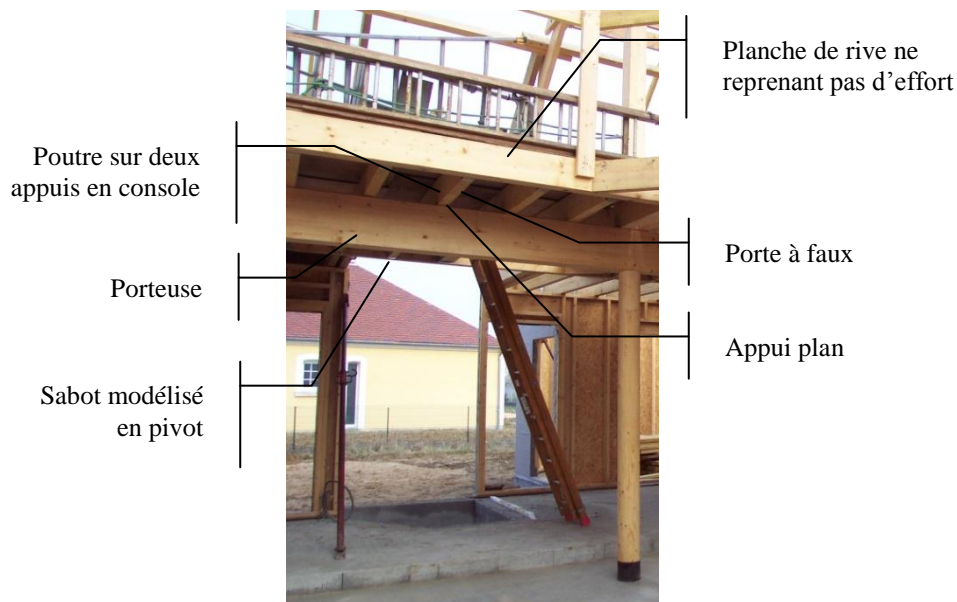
Poutre sur deux appuis en console avec une charge ponctuelle (@ MBC (Maison Bois Cruard))
